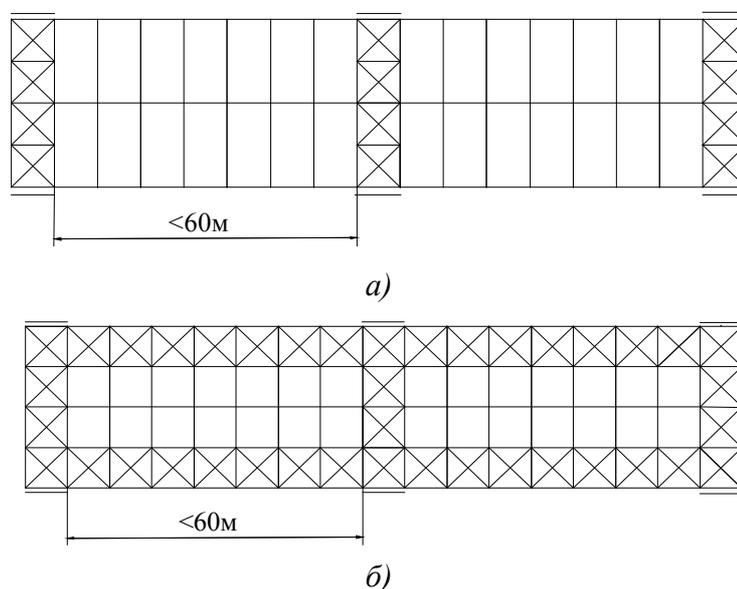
Схема расстановки горизонтальных связей: а- связи по верхнему поясу; б- связи по нижнему поясу
